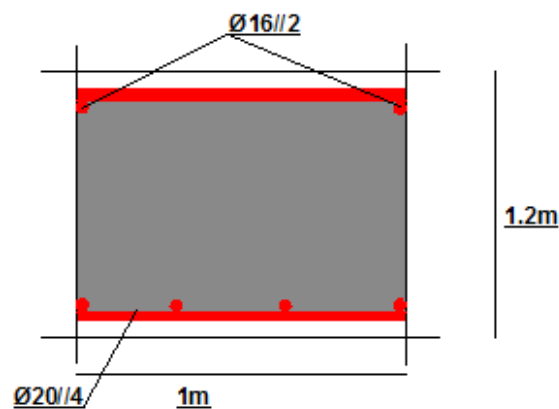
Schéma de ferrailage à mis travée dans la direction longitudinale
